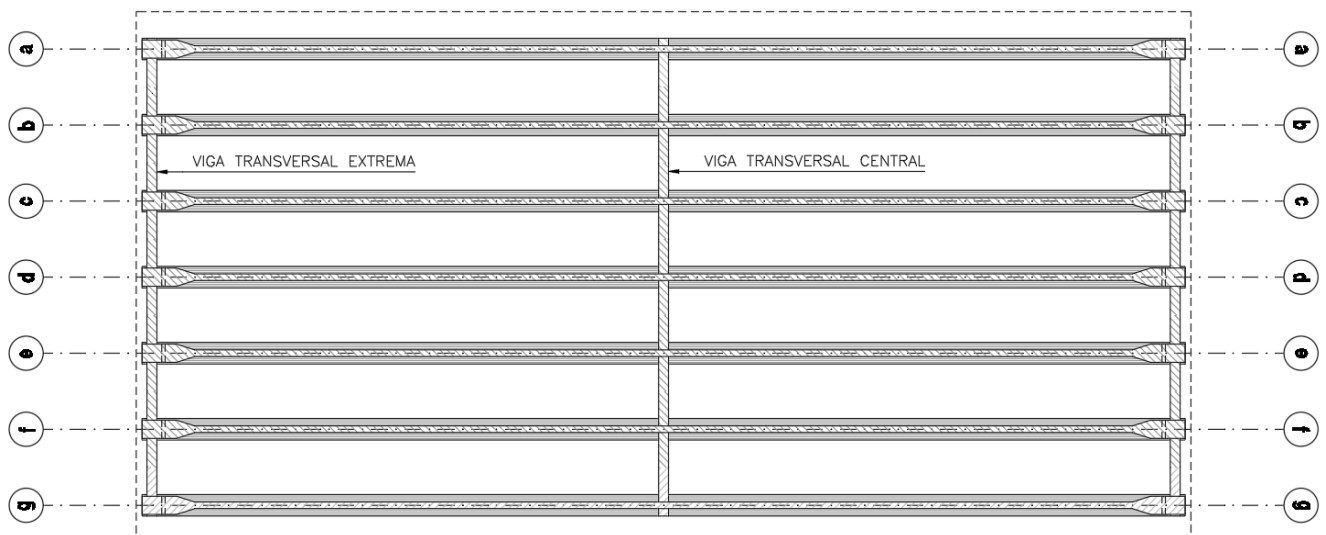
Esquema de disposición de vigas longitudinales y transversales
